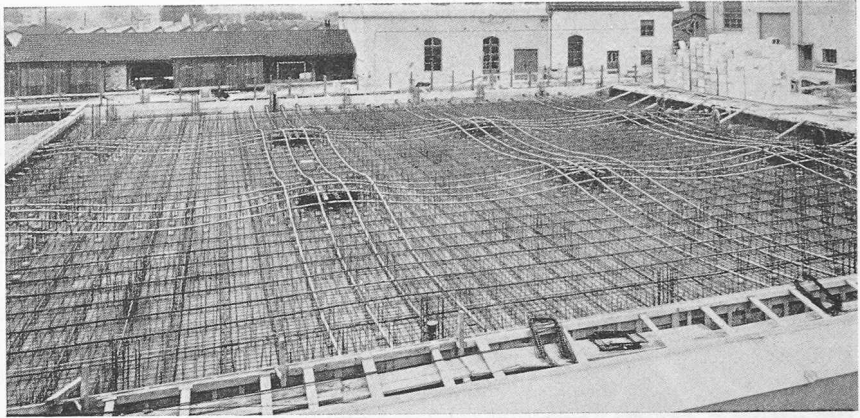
EKZ-Gebäude in Dietikon ZH, verlegte Vorspannkabel und schlaffe Armierung einer Platte
